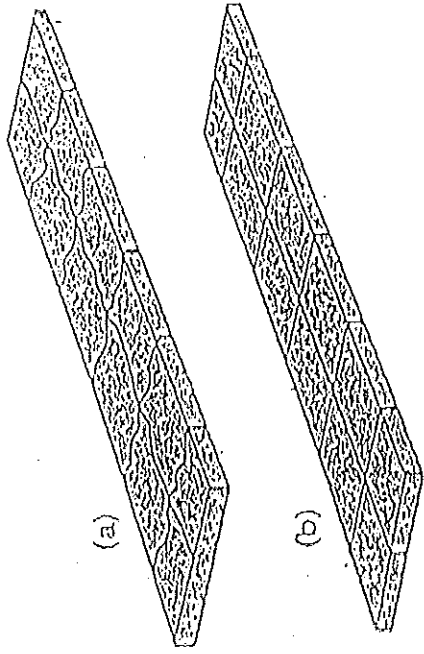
PATRÓN DE AGRIETAMIENTO PROVOCADO POR EL MEDIO AMBIENTE Y LOS ESFUERZOS DE LAS CARGAS EN UN PAVIMENTO DE CONCRETO SIN JUNTAS (B) DISEÑO ADECUADO DE LAS JUNTAS PARA CONTROLAR LA UBICACIÓN Y GEOMETRÍA DE LAS GRIETAS EN UN PAVIMENTO DE CONCRETO.
